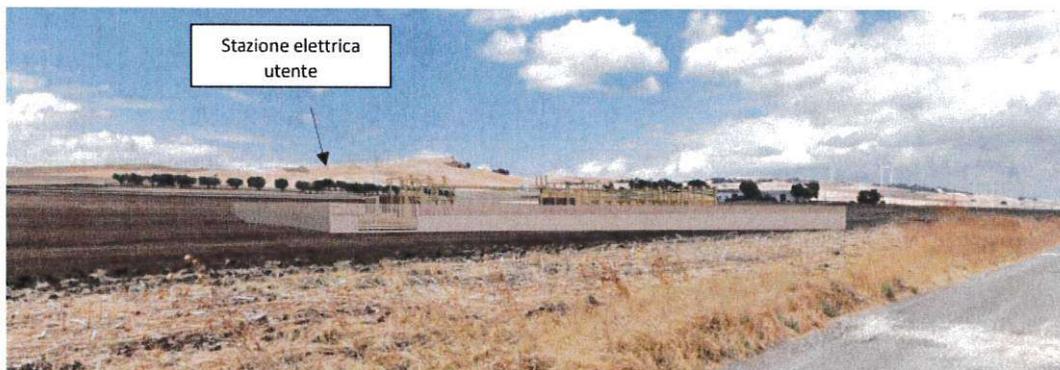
b – Situazione post-operam – vista dalla strada provinciale SP79
